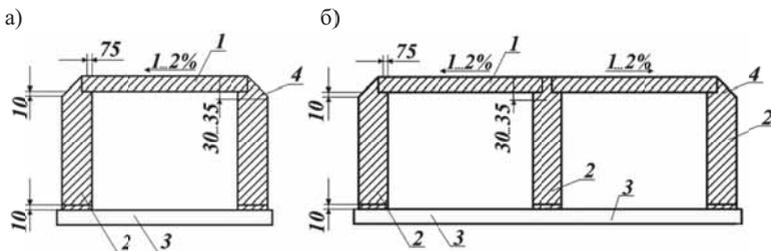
Канал с бетонными стенками по ТС-01-01:
